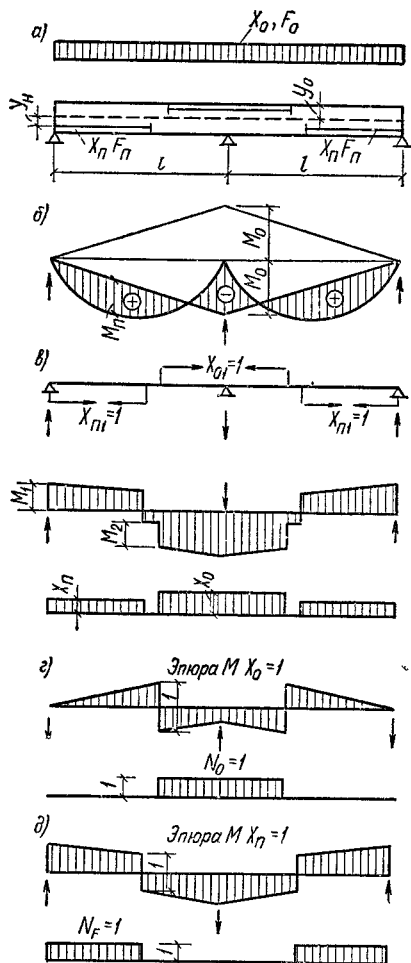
К расчету неразрезной балки (размещение затяжек в неразрезных балках)
